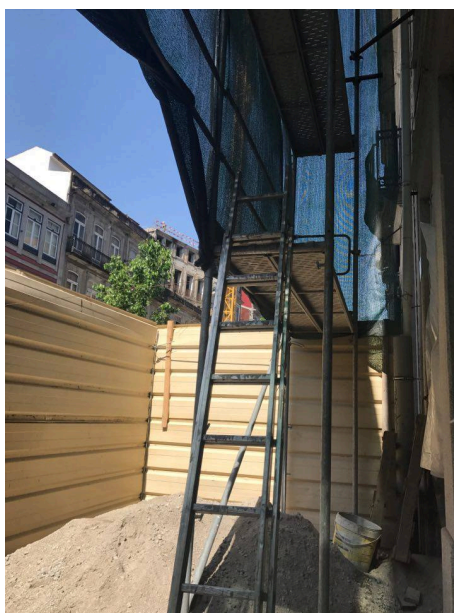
Fotografia do estaleiro implementado na obra e das estruturas de suporte à reabilitação das fachadas
